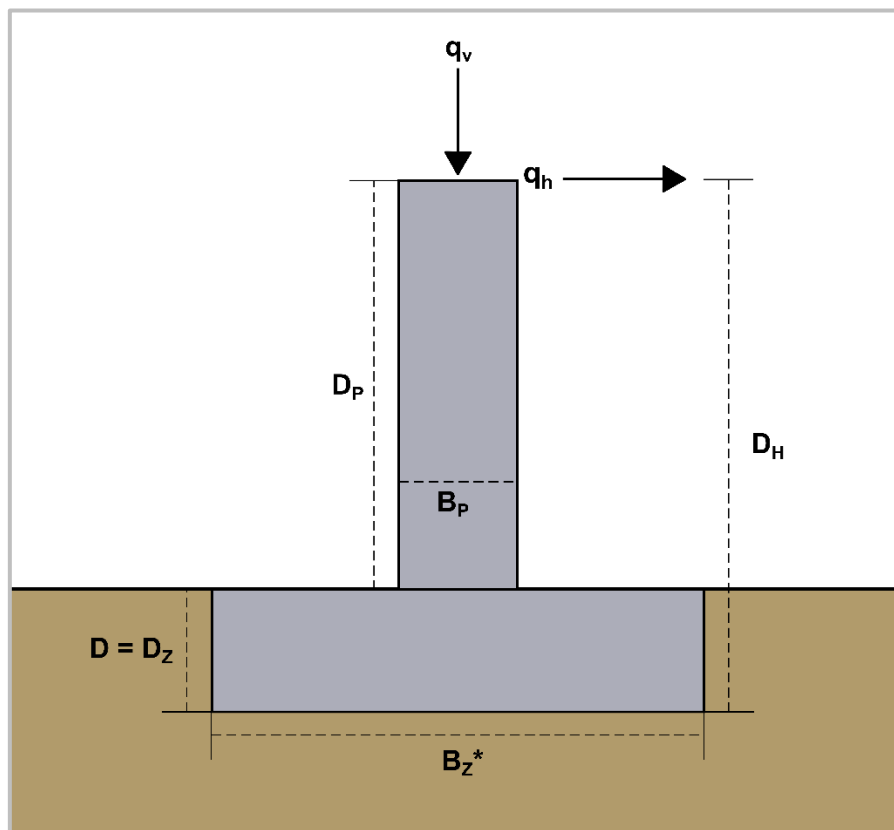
Esquema representativo de la configuración de la cimentación superficial utilizada en el estudio, con indicadores de las dimensiones relevantes para los cálculos realizados. El largo de la zapata y la pila no queda reflejado.
